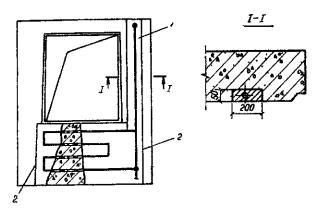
Пример размещения труб нагревательного элемента в штробе наружной стеновой панели
